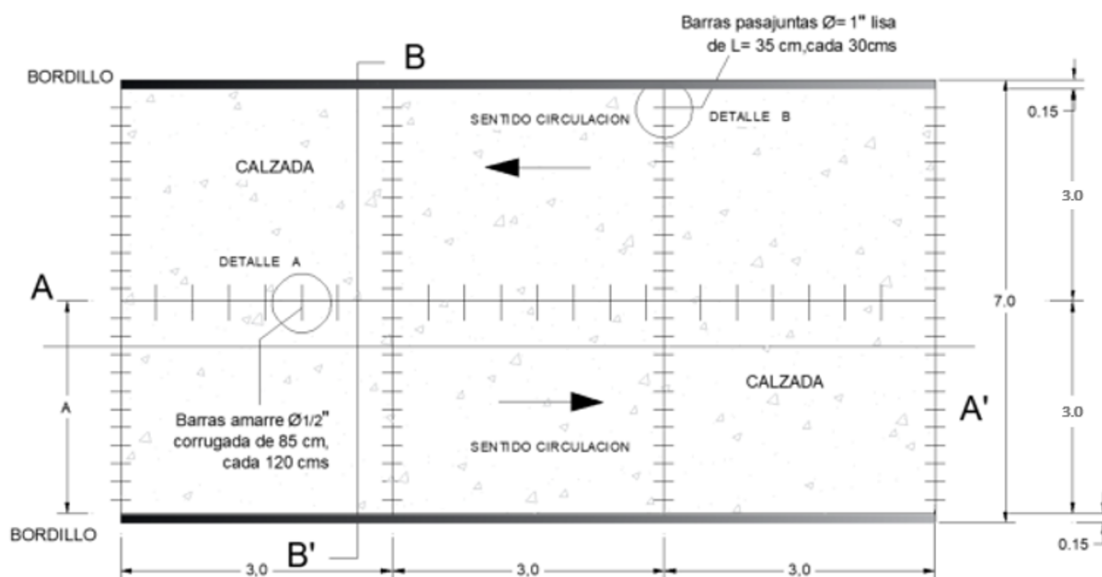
Vista en Planta Modulación de Losa de Pavimento
